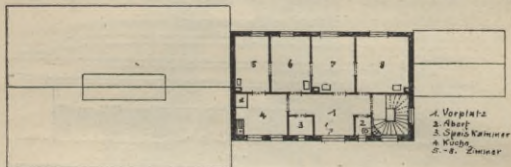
M. = 1:600. Empfangsgebäude Weilheim/Teck. Grundriß des ersten Stocks.
